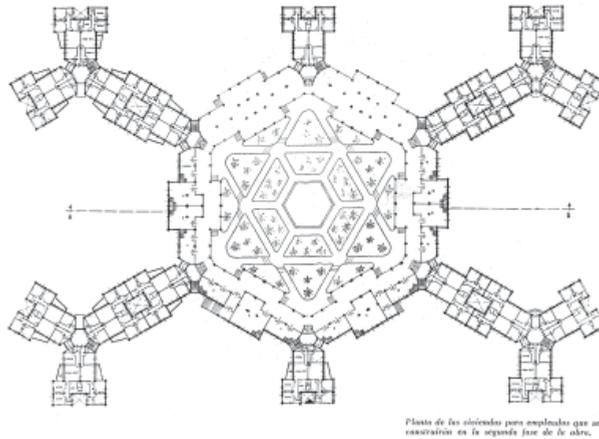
Plano de bloques en Y (solución descartada) Fuente: Revista Gran Madrid
